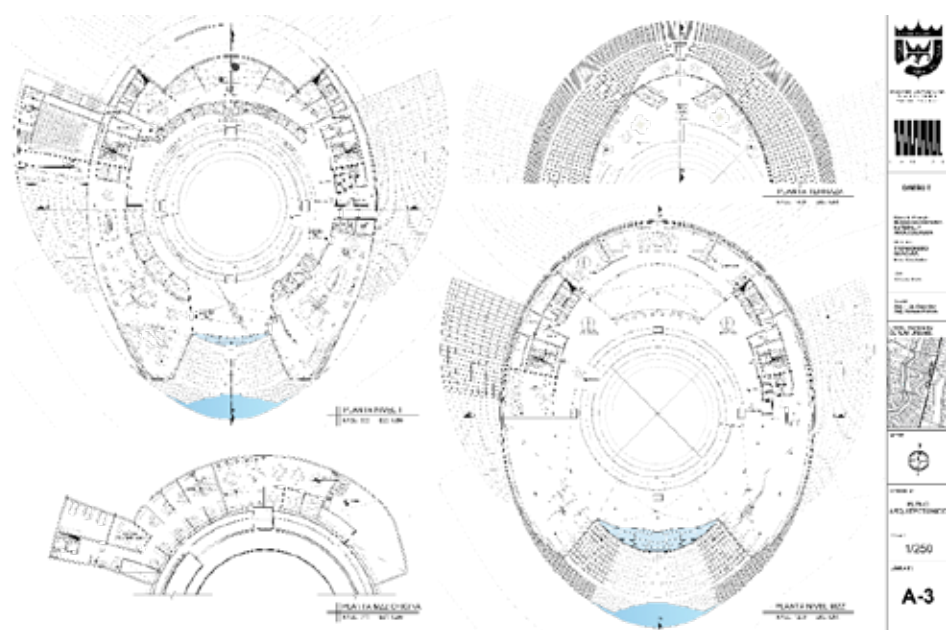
Planta nivel 1, mzz y terrazas. Fuente: Autor (2021)
